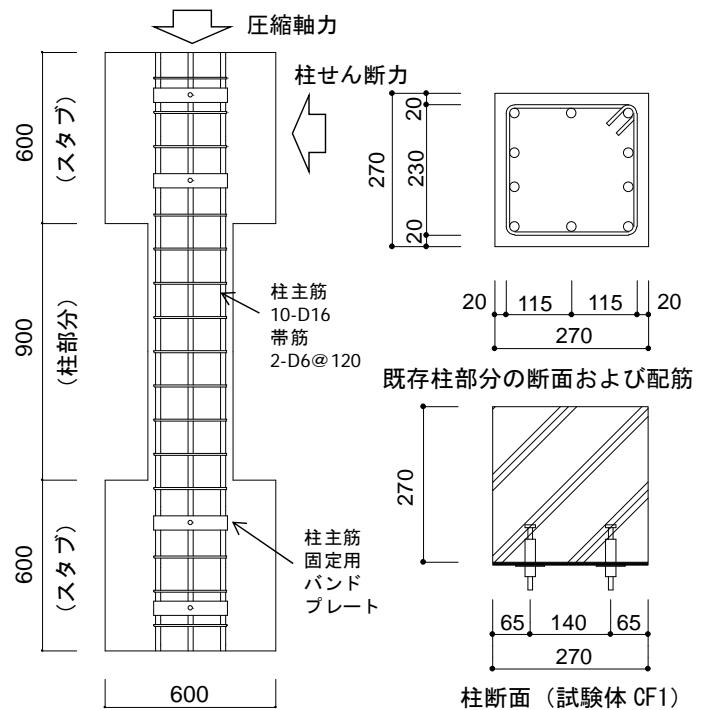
試験体の断面・形状および配筋詳細 (単位 ; mm)
